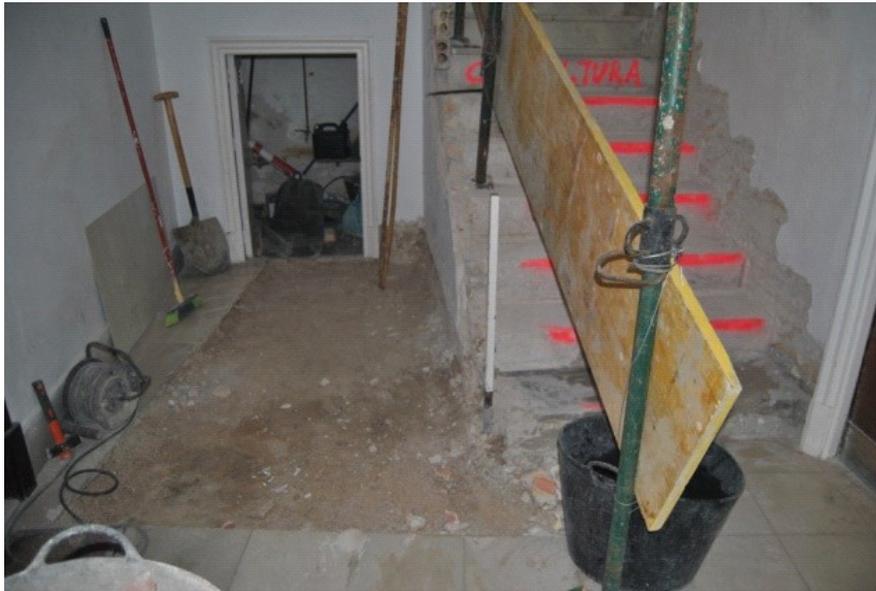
Imagen III. Acondicionamiento del Área de Intervención en Planta Baja del Edificio.
